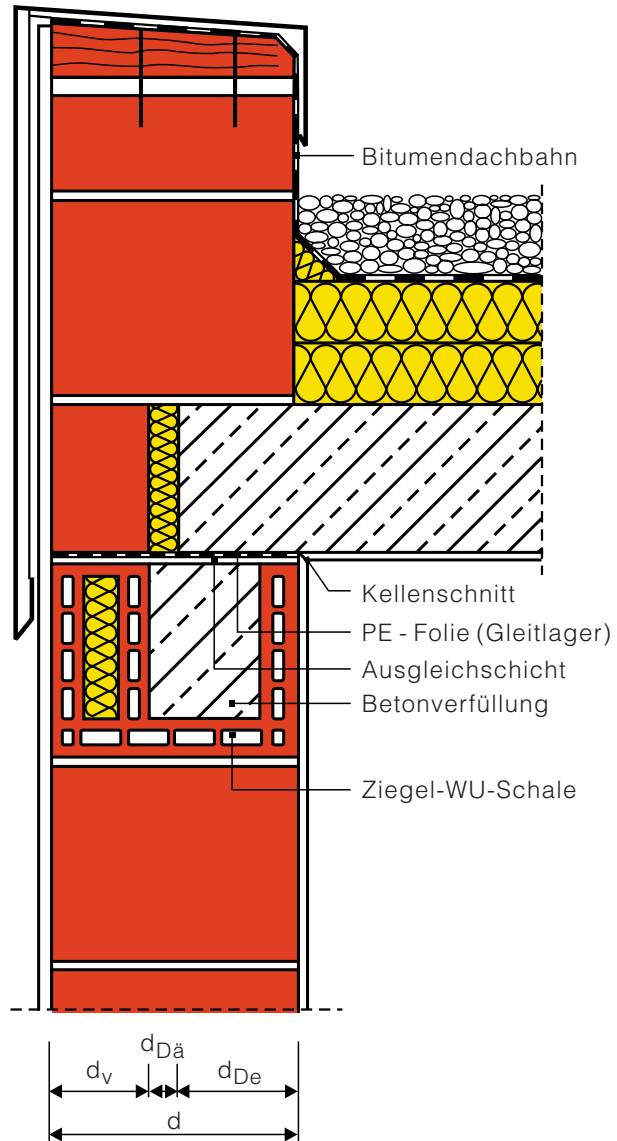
Außenwand-Decken-Knoten einer obersten Geschossdecke mit Gleitlager am Wandkopf; Ringbalken in Wandquerschnitt
